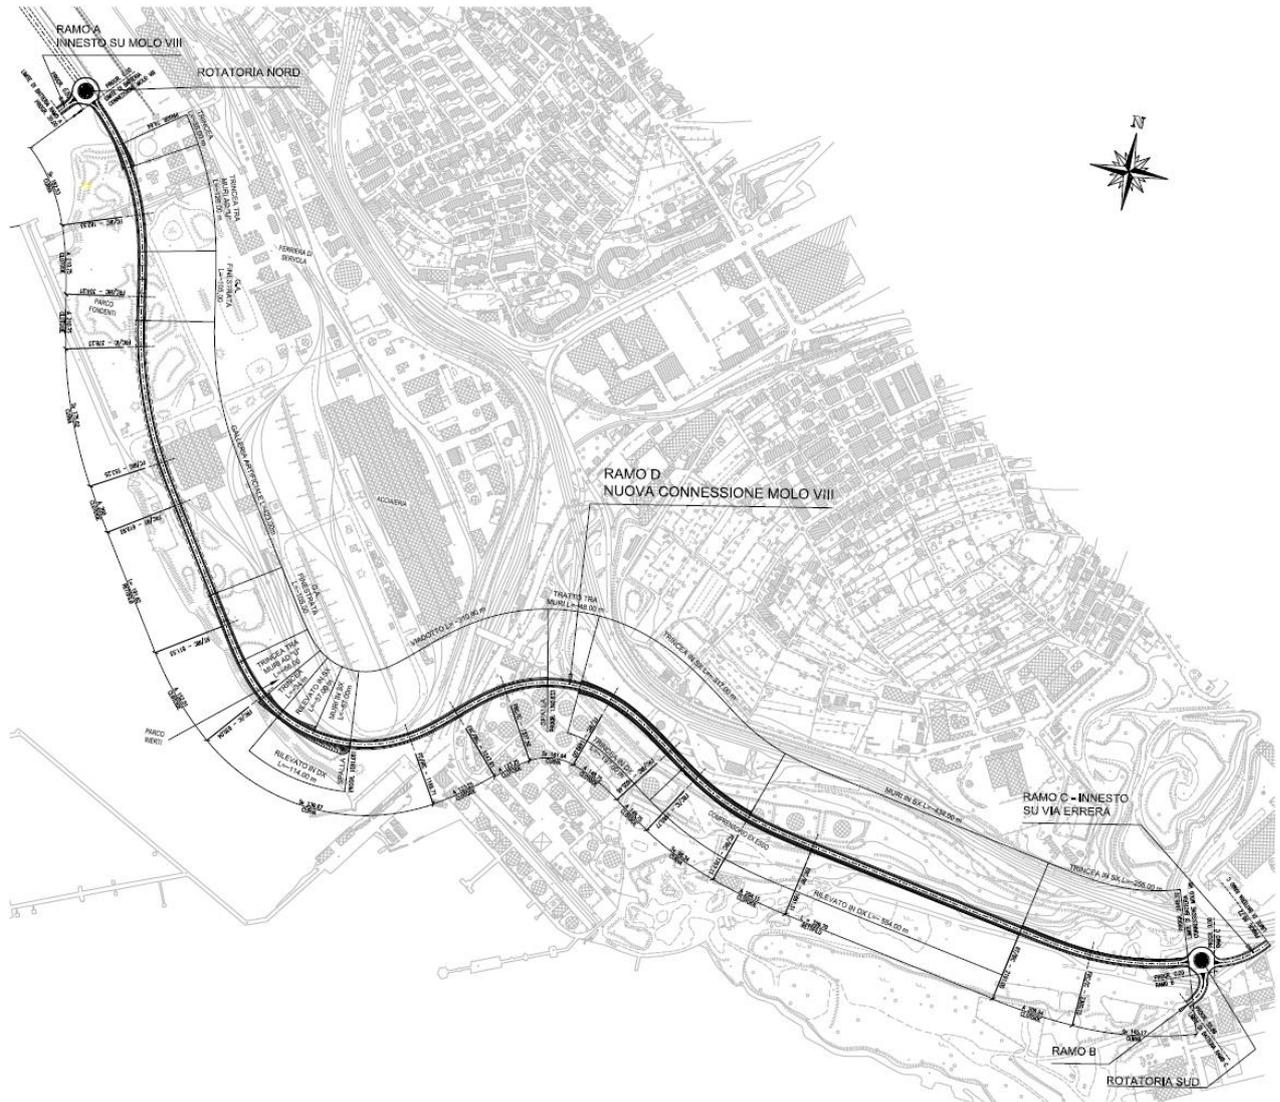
PLANIMETRIA DEL NUOVO TRACCIATO DI RACCORDO DEL MOLO VIII CON LA GRANDE VIABILITÀ TRIESTINA.
